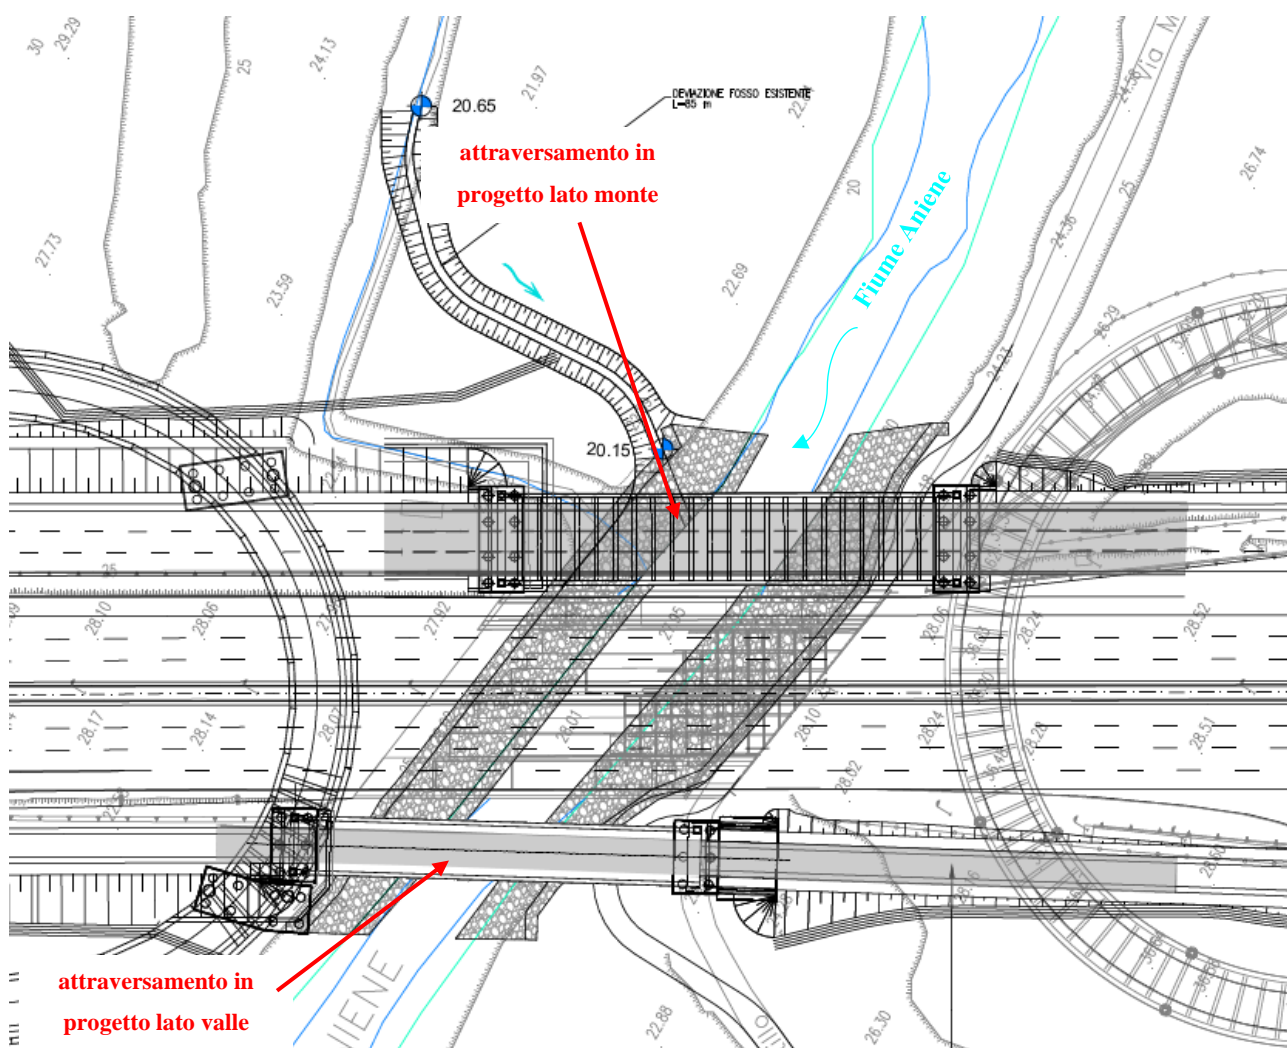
Planimetria di progetto degli attraversamenti sul fiume Aniene
